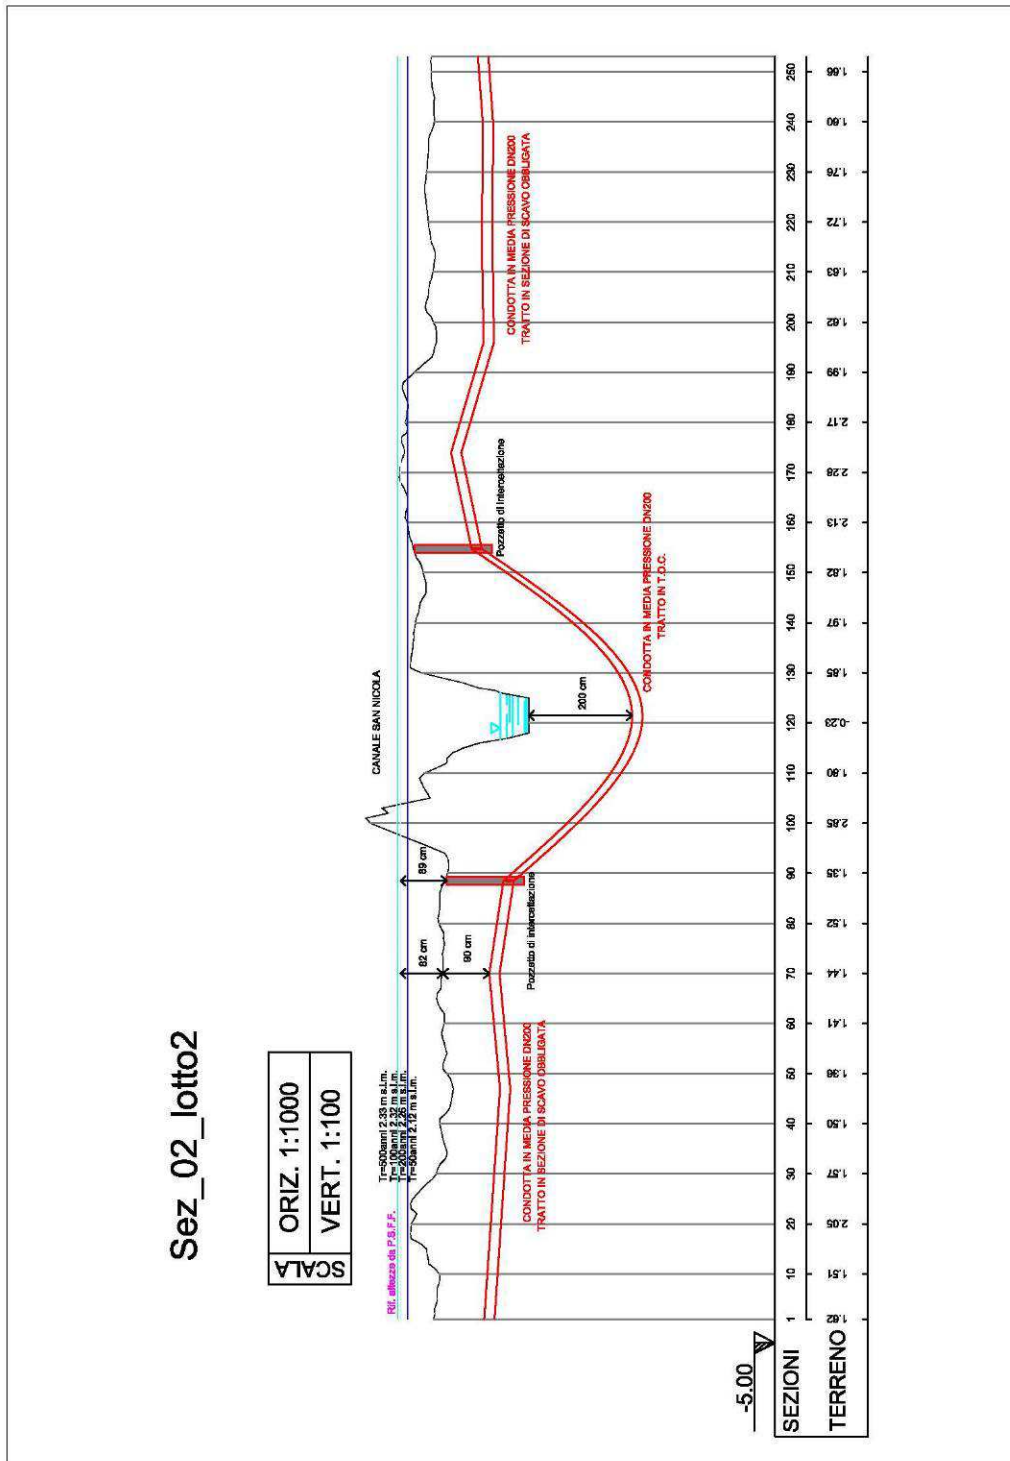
Sezione “Sez_02_lotto2”. Stralcio della sezione dell’attraversamento del Canale San Nicola.
